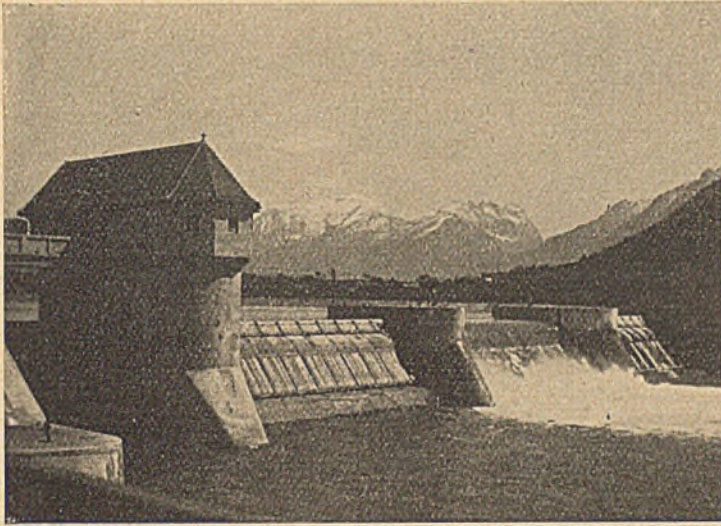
Dachwehranlage Hallein (Oesterreich).
